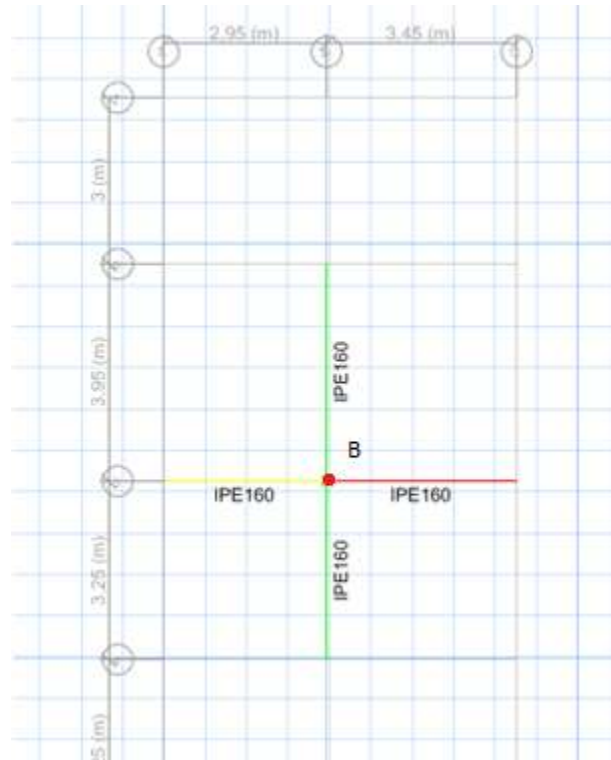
LONGITUDES DE LAS VIGAS EN EL PUNTO B
